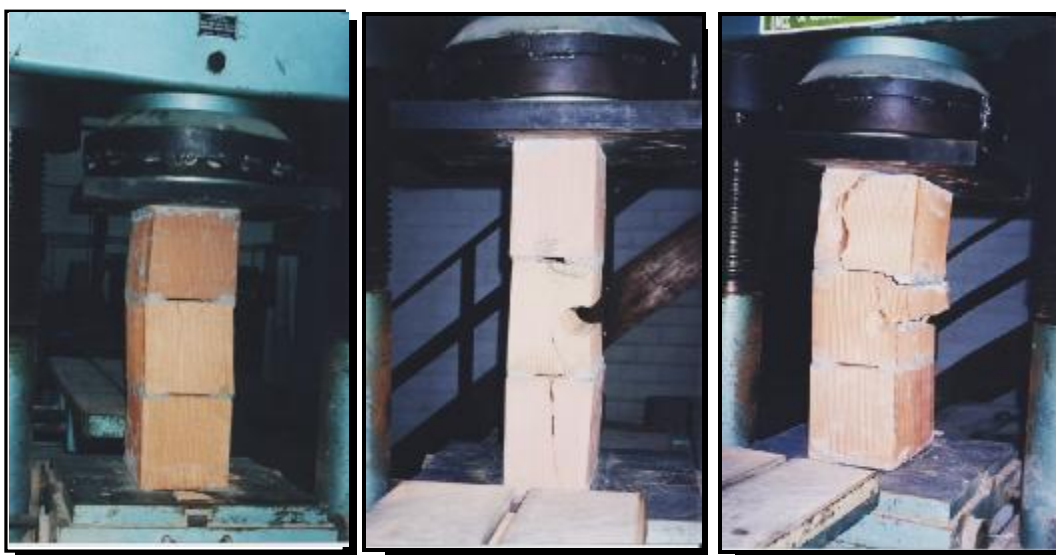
Ensaio de prismas de três blocos superpostos - junta longitudinal de assentamento, situação de obra.
